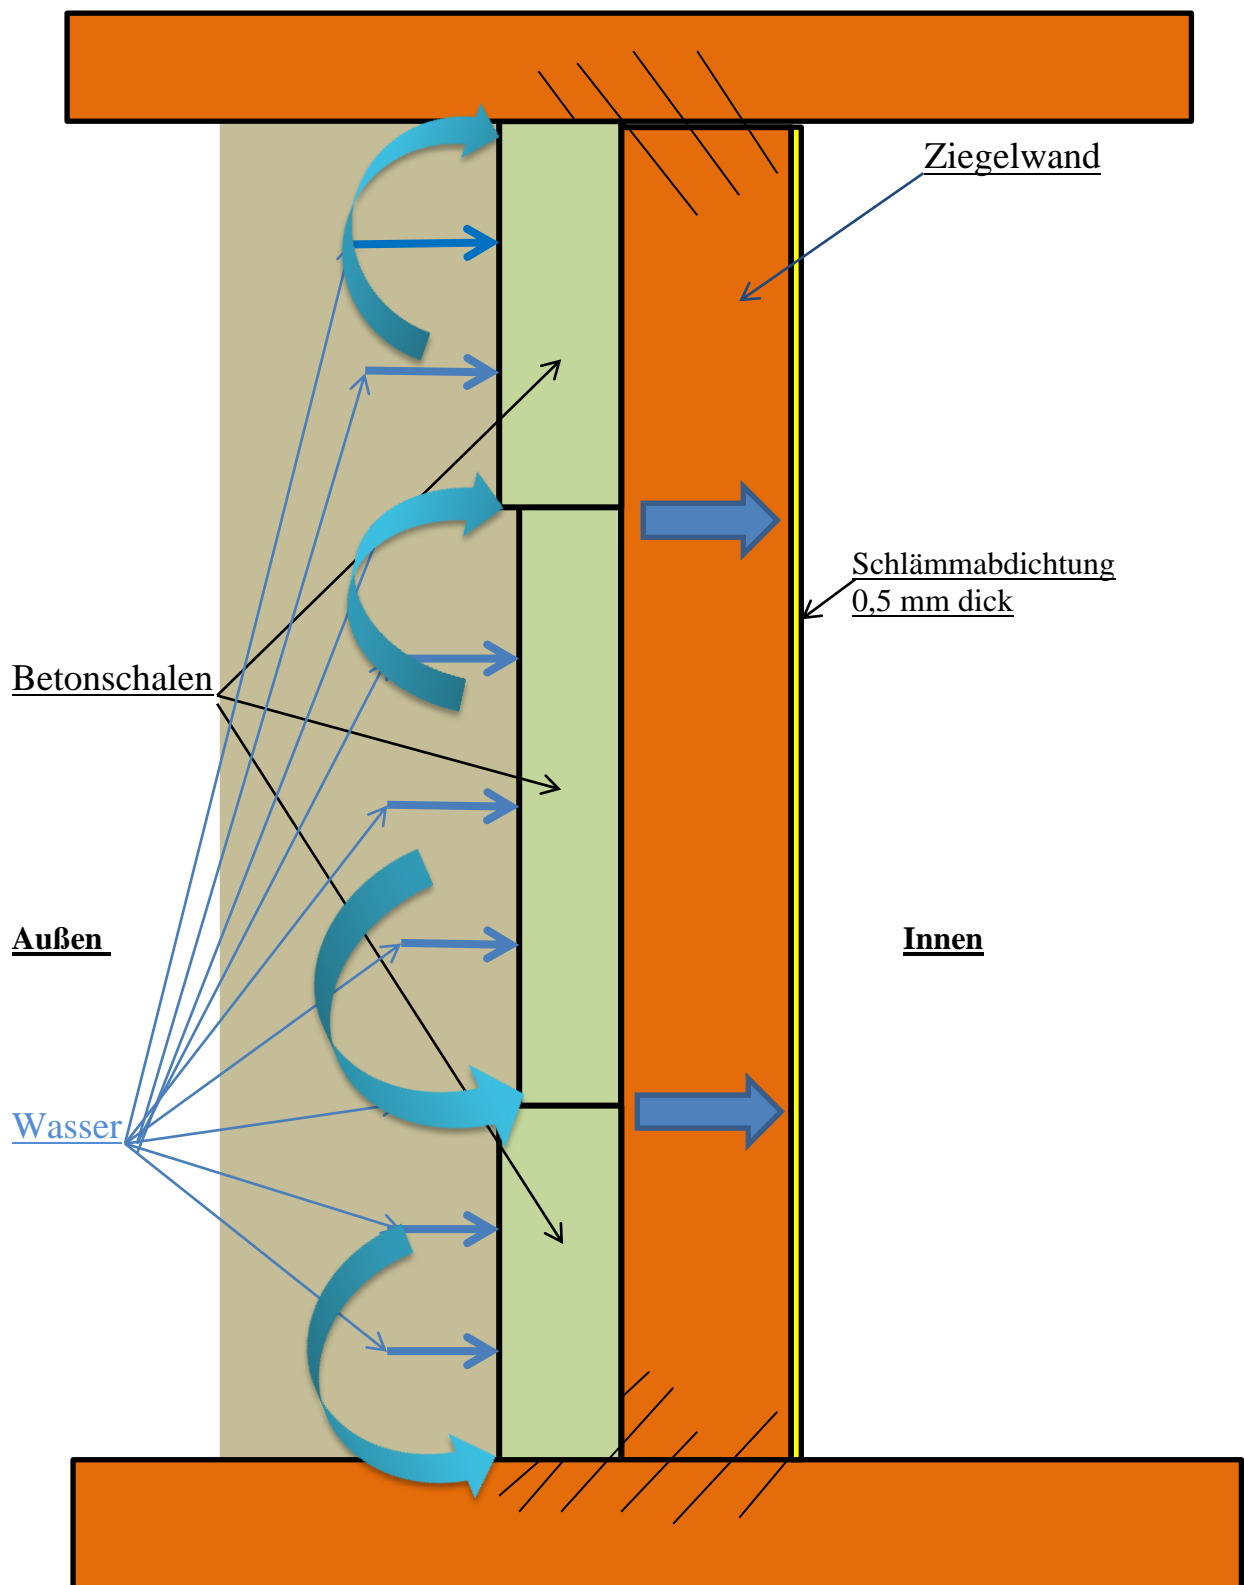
Grundriss: Durch die Wand sickernes Wasser deutet auf fehlende Fugenbänder in den Arbeitsfugen der Betonteile hin.
